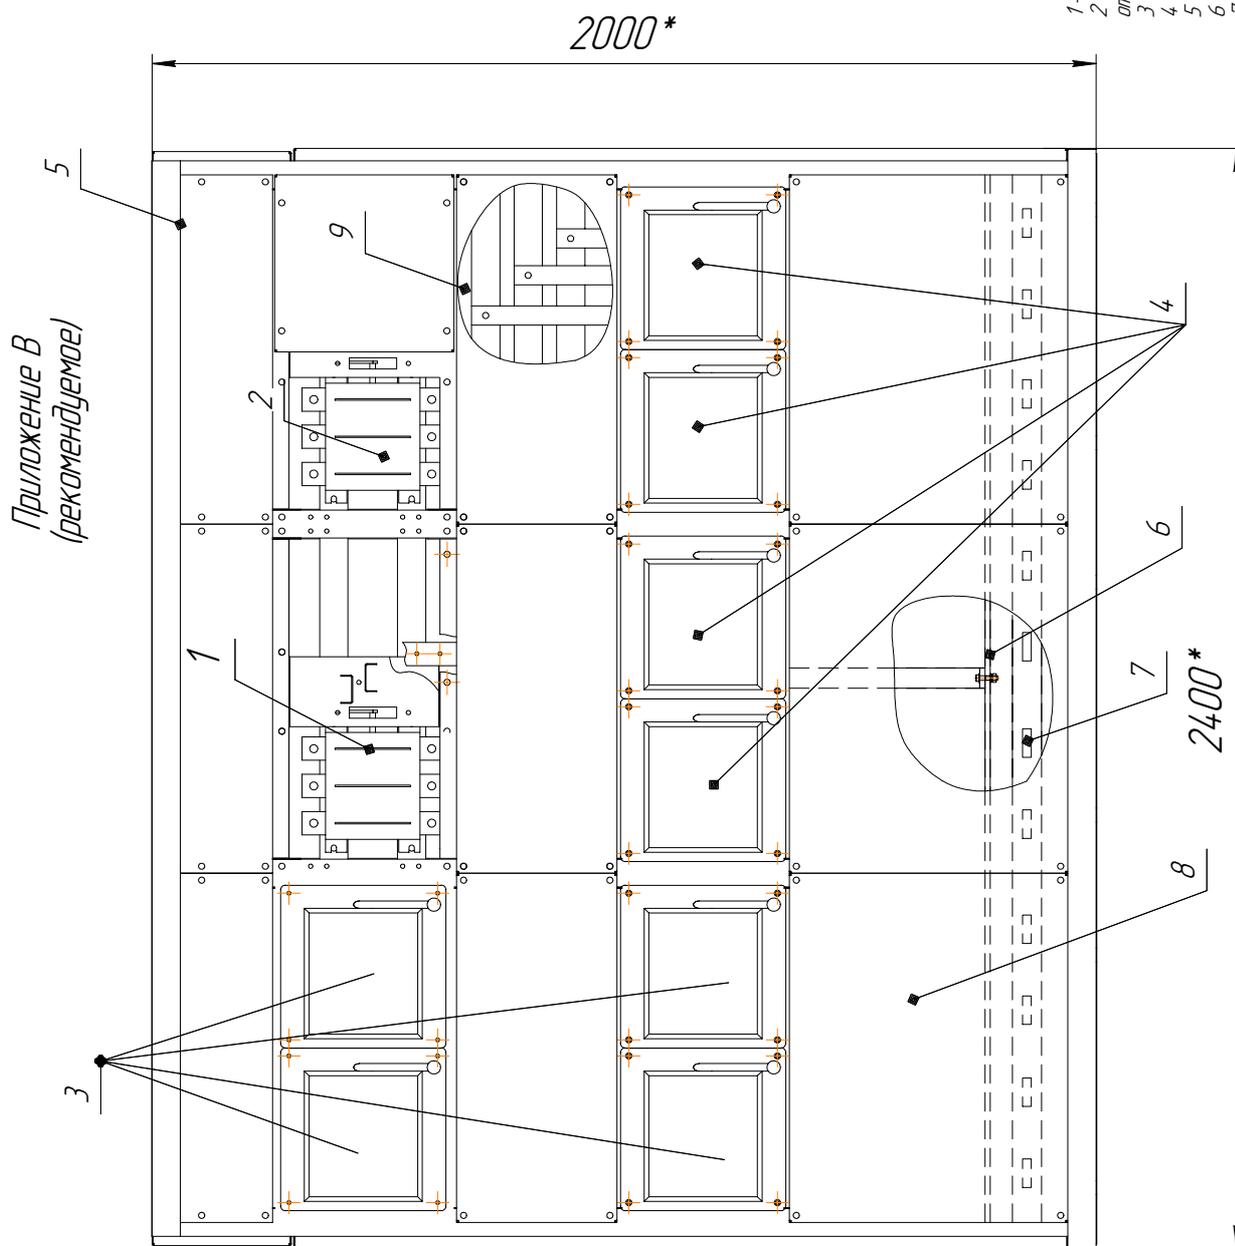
Установка модуля электротехнических блоков на фундамент
